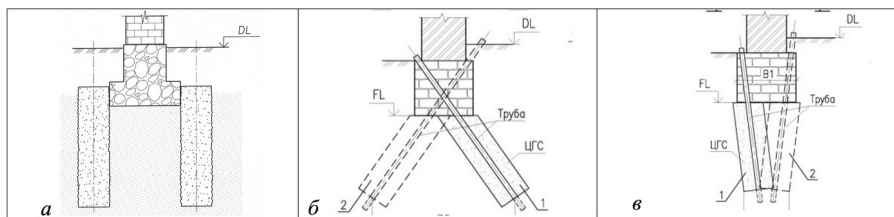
Схемы усиления ленточных фундаментов с помощью рядов ГЦЭ:
